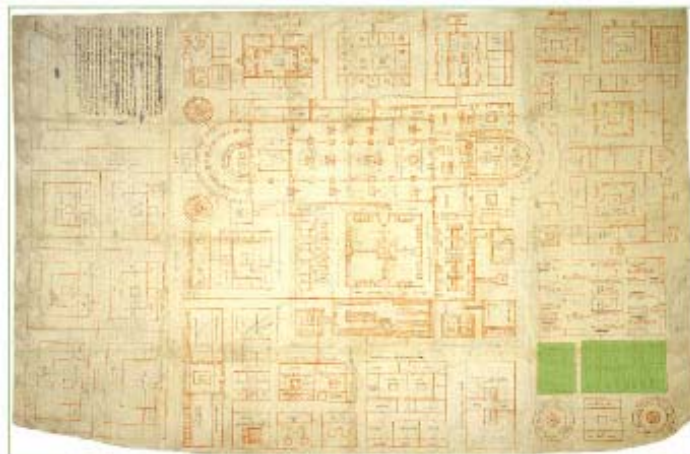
Klosterplan, Planausschnitt Gemüsegarten und Haus des Gärtners
